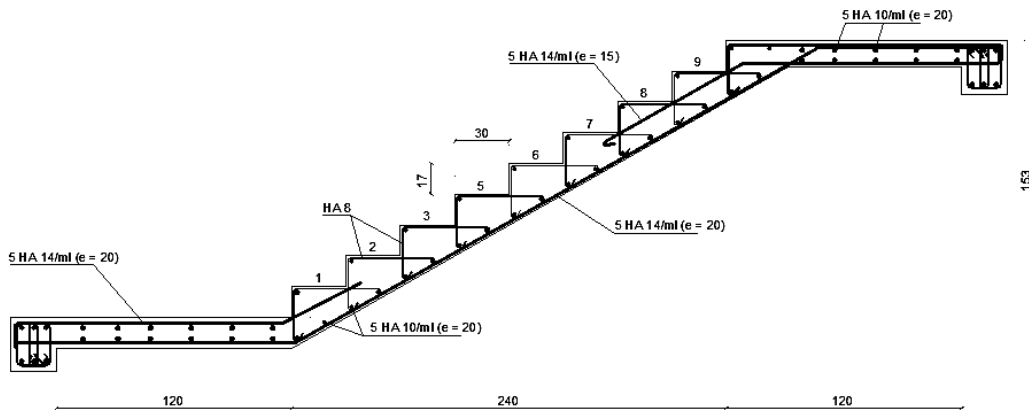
Schémas de ferrailage d'escaliers en béton léger.
